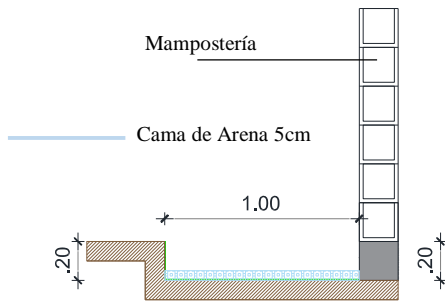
Detalle de Colocación Geo Textil en Cadena (S/E)
